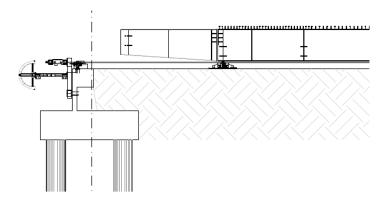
Vista esquemática del Estribo E2 con los equipos de tiro.
